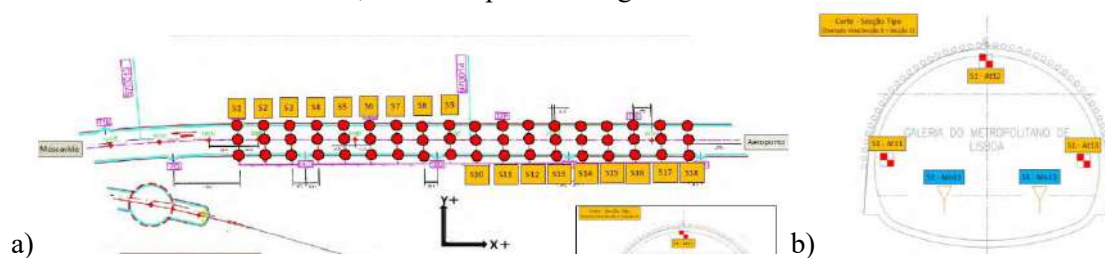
a) Planta de Instrumentação Galeria ML. b) Corte Tipo Instrumentação.
